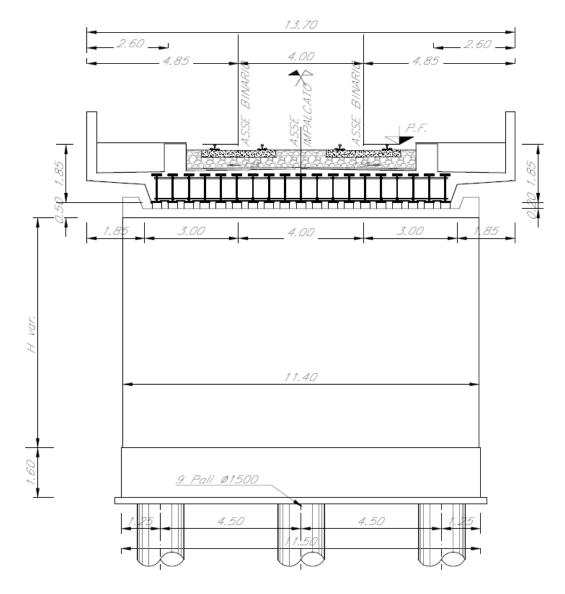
Spalla doppio binario – prospetto trasversale
